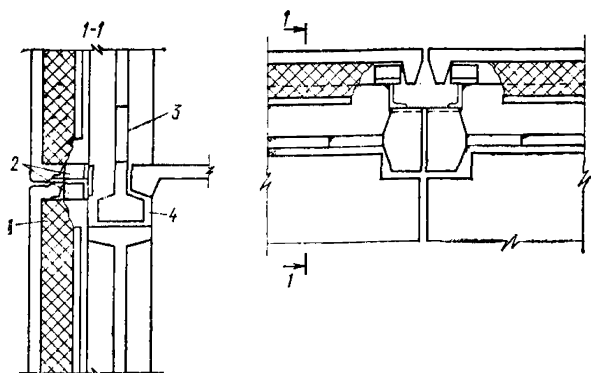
Крепление торцовых наружных панелей к железобетонным несущим панелям
